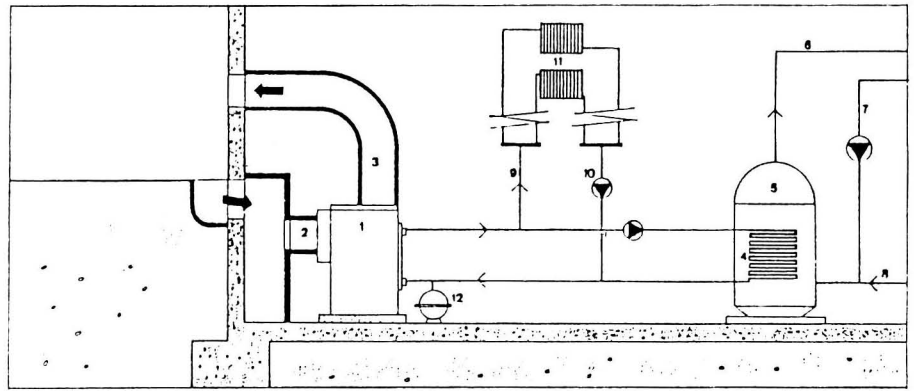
INSTALACION MIXTA ACS + CALEFACCION
